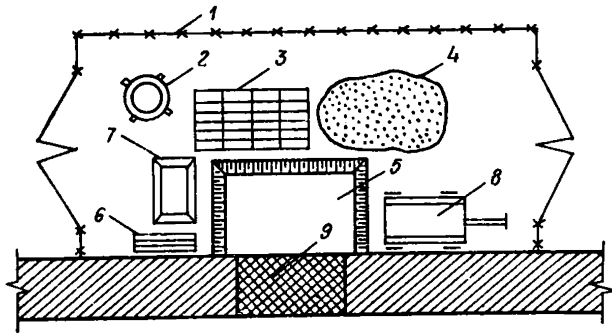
Схема организации работ по замене участка гидроизоляции стены
